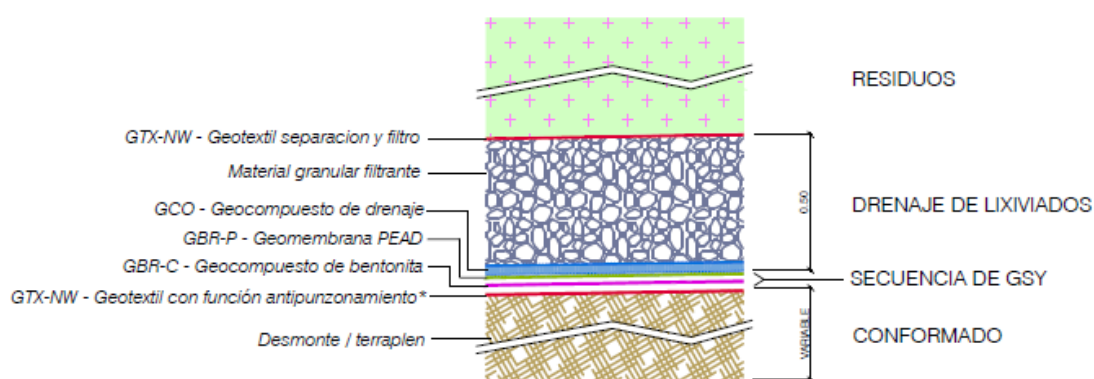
Detalle secuencia impermeabilización en el fondo de vaso
